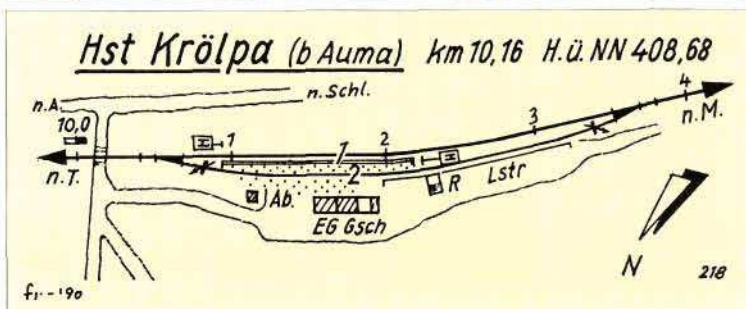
(rechts): Gleisplan der Haltestation Krölpa.
